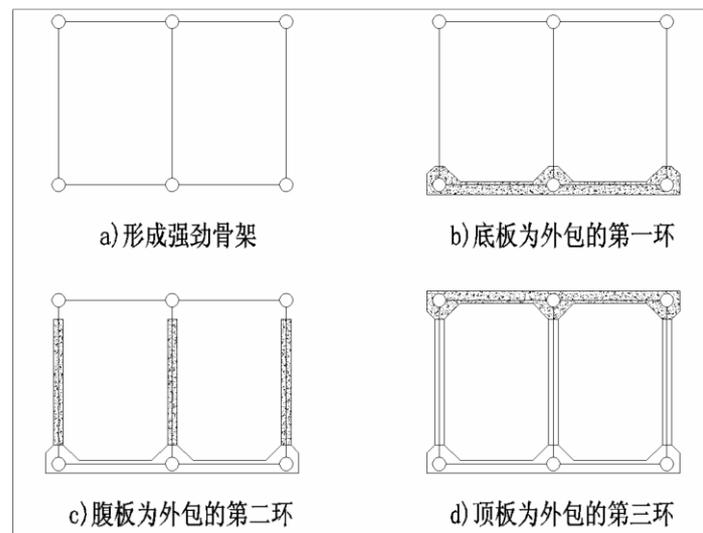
三环外包主拱混凝土的施工缝位置示意图
